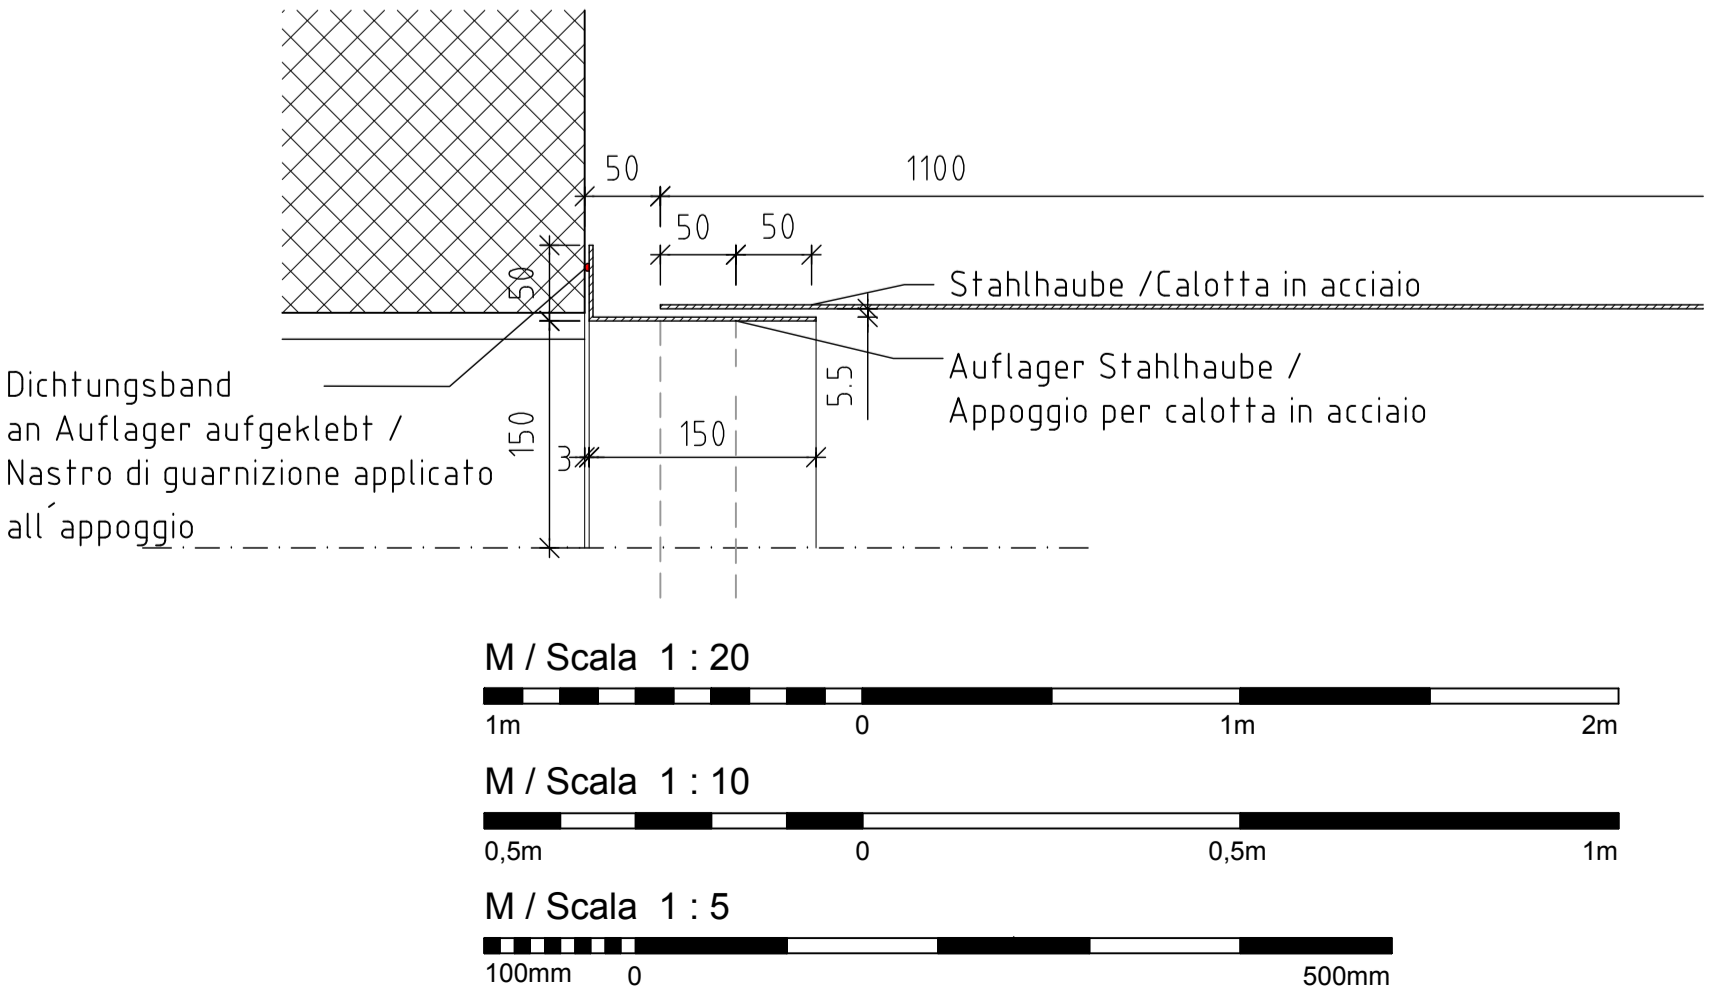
5 / Dettaglio C, Scala 1:5
